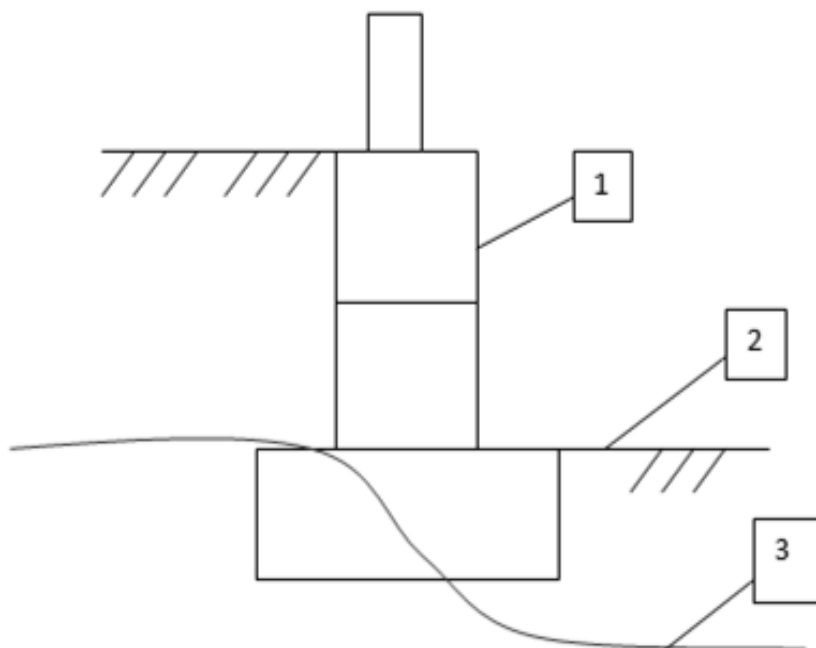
Допоміжне ущільнення ґрунту під фундаментом (1-існуючий фундамент; 2-новий фундамент; 3-межі зон деформації ущільнення ґрунту в основі)
